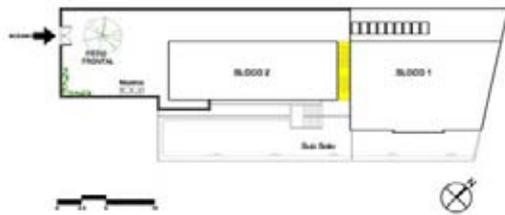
Planta de setorização da escada de ligação ao subsolo.
